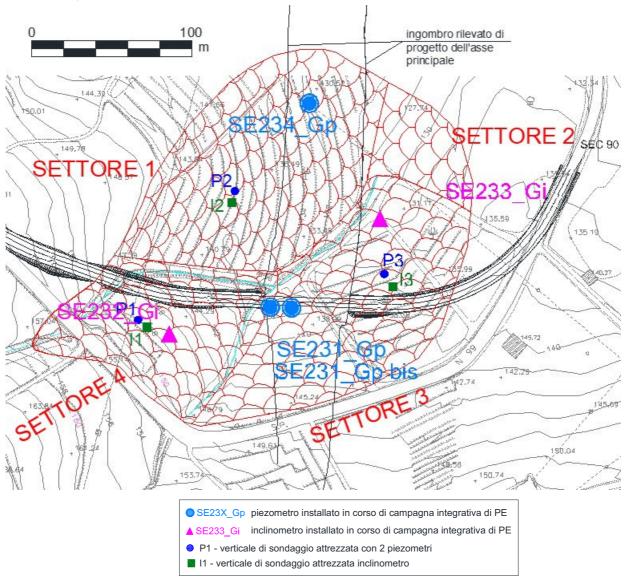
Planimetria con ubicazione della strumentazione di monitoraggio.
